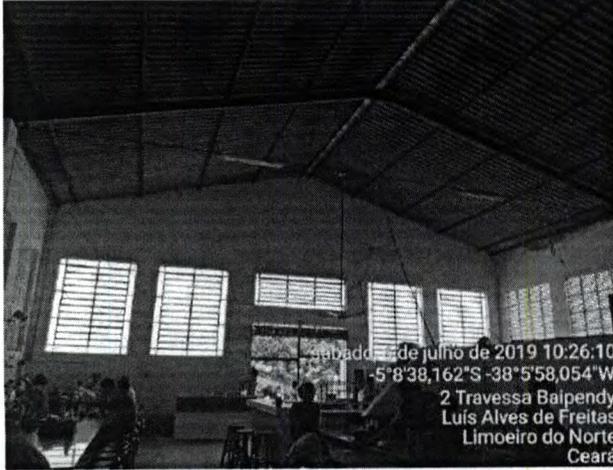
Vista interna da fachada principal do Mercado de Carnes e Peixes.
